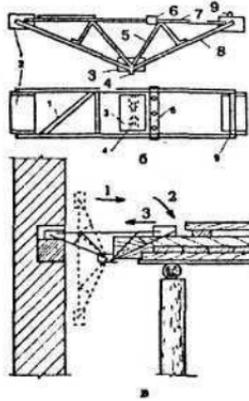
Ремонт деревянных перекрытий по металлическим балкам (продолжение):
